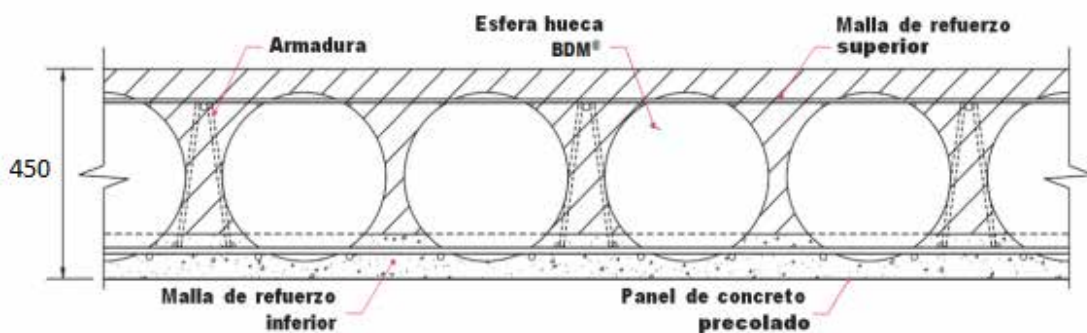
Detalle de la losa bubbledeck. Fuente: El Autor (2020).
